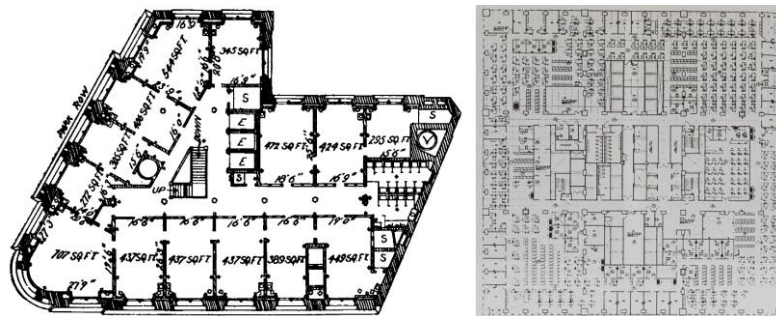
Planta de edifício no sistema *cage construction* de 1890 com 20 pavimentos (esq.) [3] e no sistema metálico tubular em aço de 1970 com 108 pavimentos (dir.)
